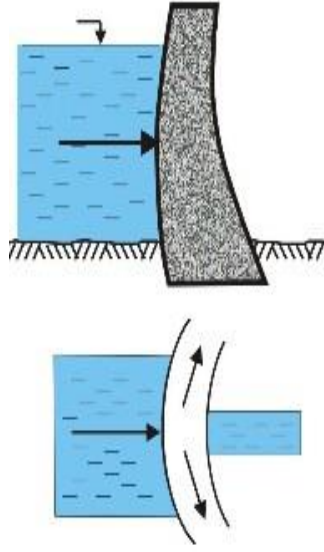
Beton Ağırlık Baraj Kesiti.
